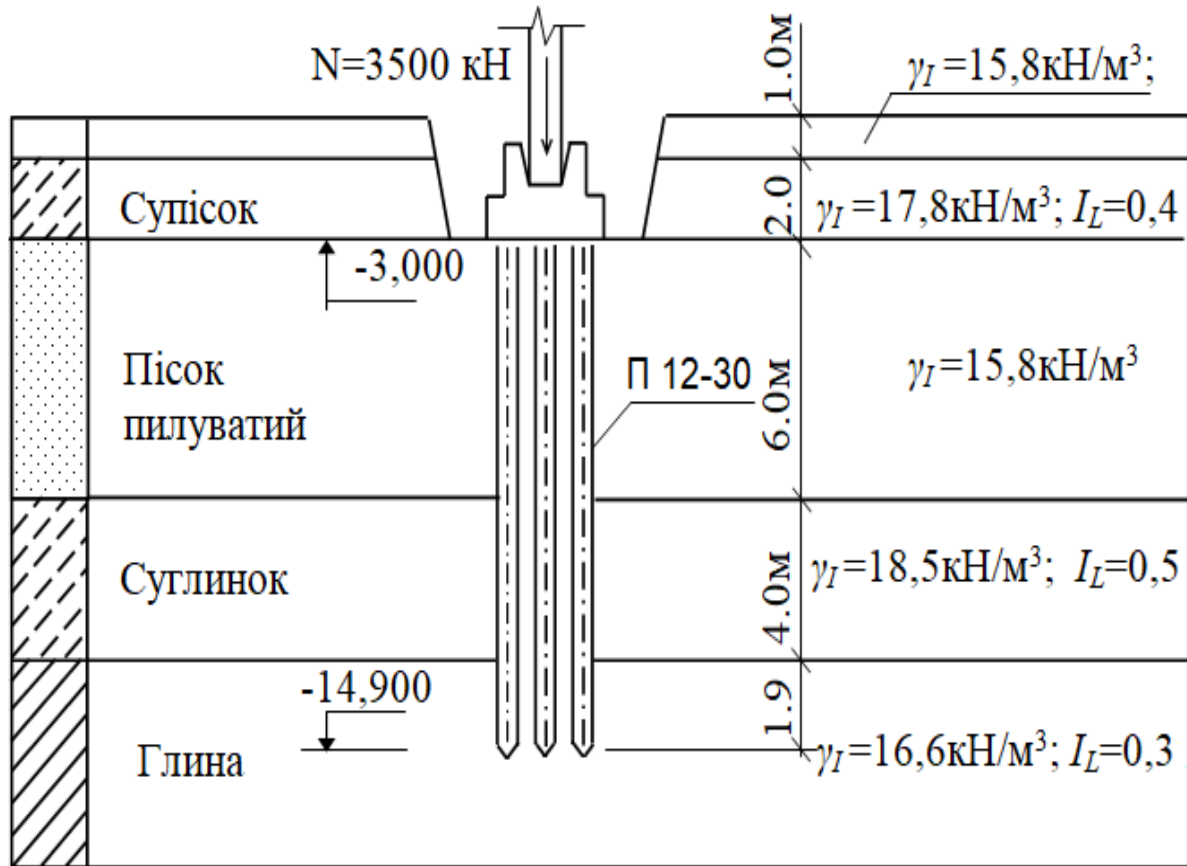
Схема розташування пального фундаменту у ґрунті
